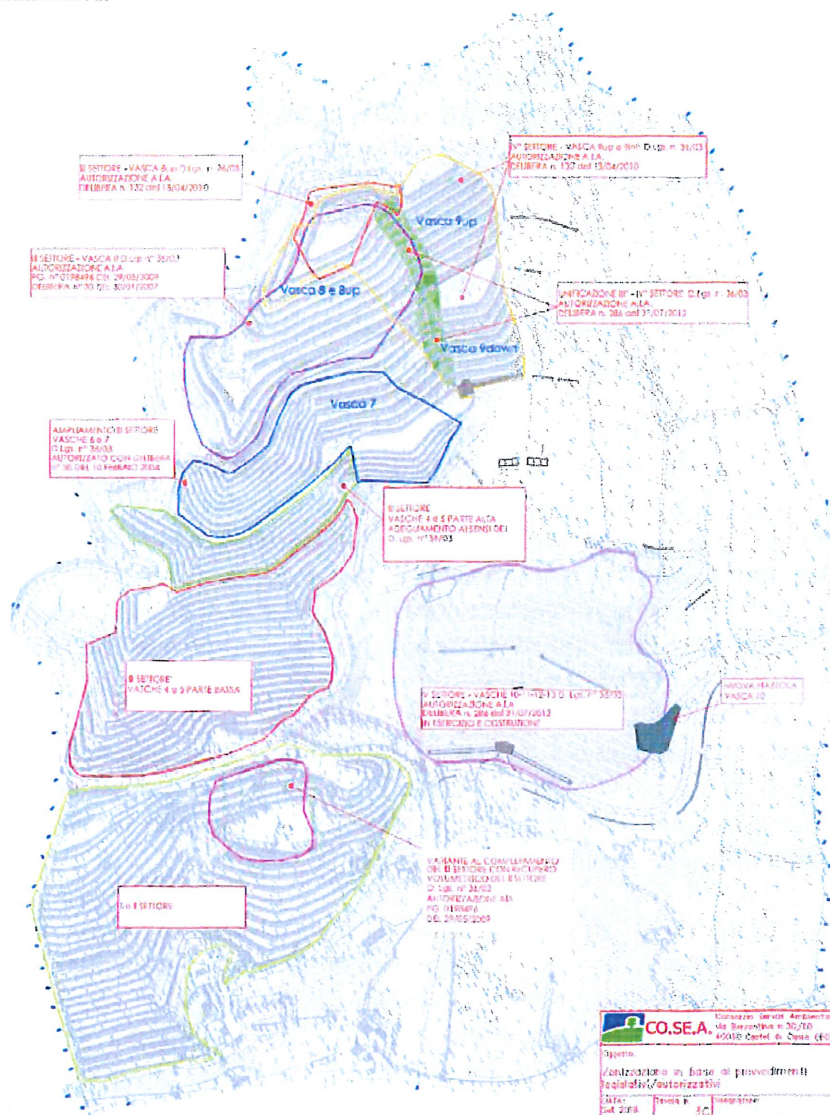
planimetria con la corretta denominazione di tutte le vasche e dei rispettivi riferimenti autorizzativi.
